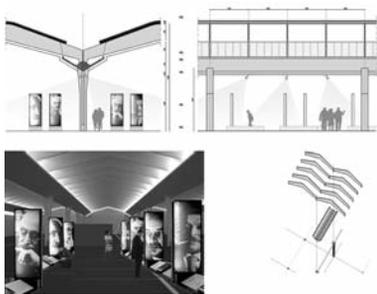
Dettaglio di una campata tipo all'interno dello spazio espositivo: prospetto frontale e laterale, esploso assometrico e modello virtuale, progetto di rifunzionalizzazione
